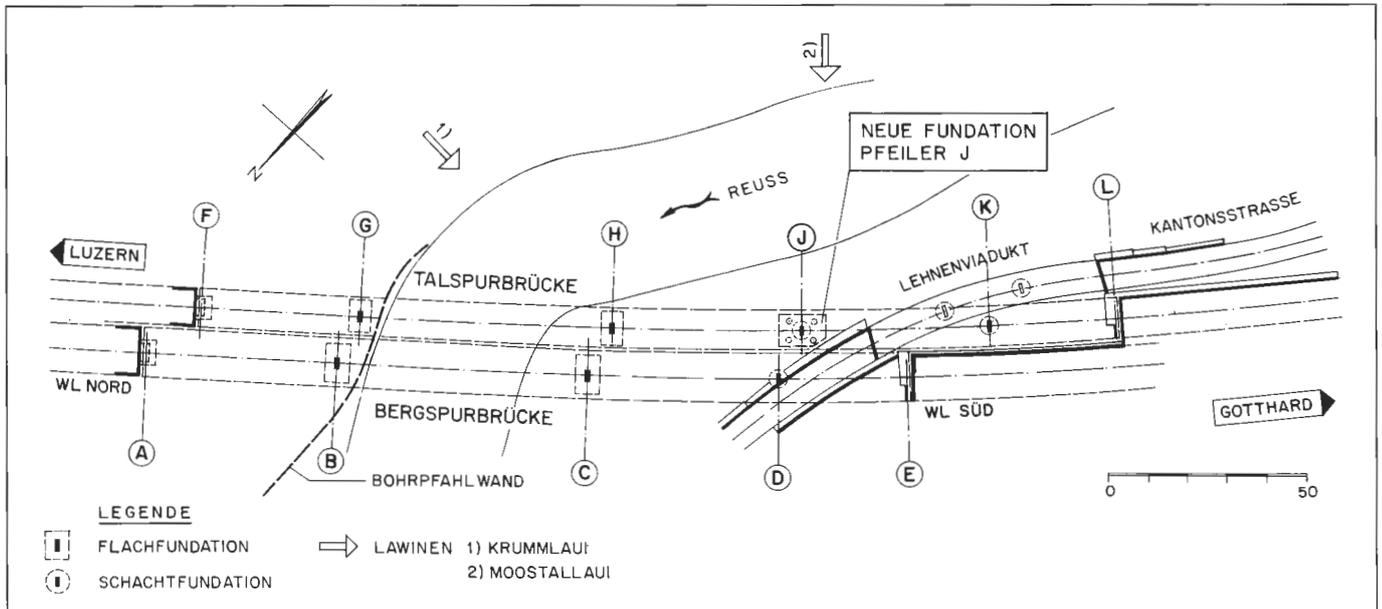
Übersicht Unterbau, Foundation Pfeiler und Wiederlager
